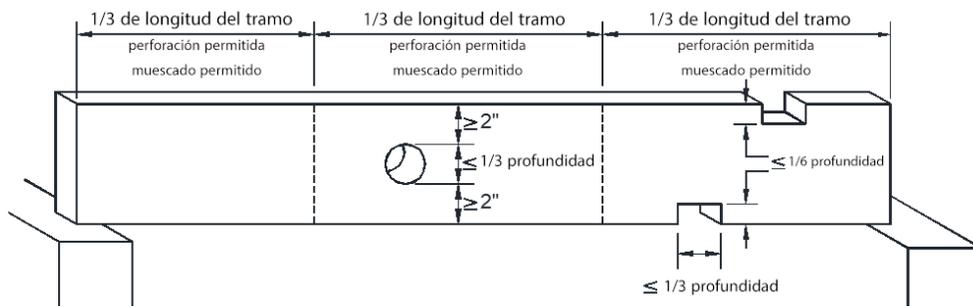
PERFORACIÓN Y MUESCADO DE VIGAS
